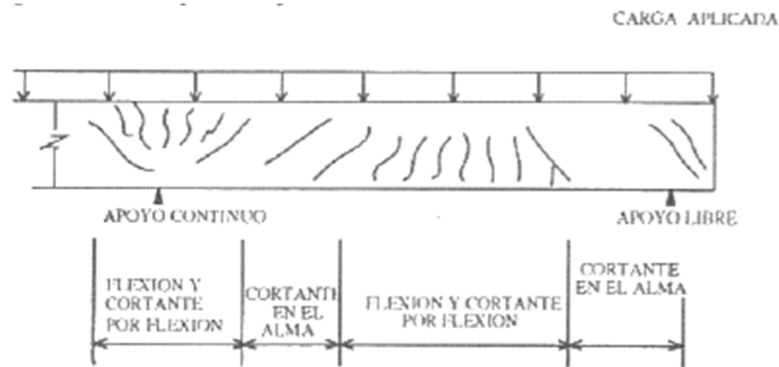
Tipo de agrietamiento en vigas de concreto
